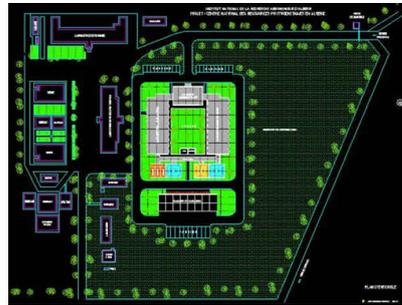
INRAA Plan d'ensemble bâtiment principal.
